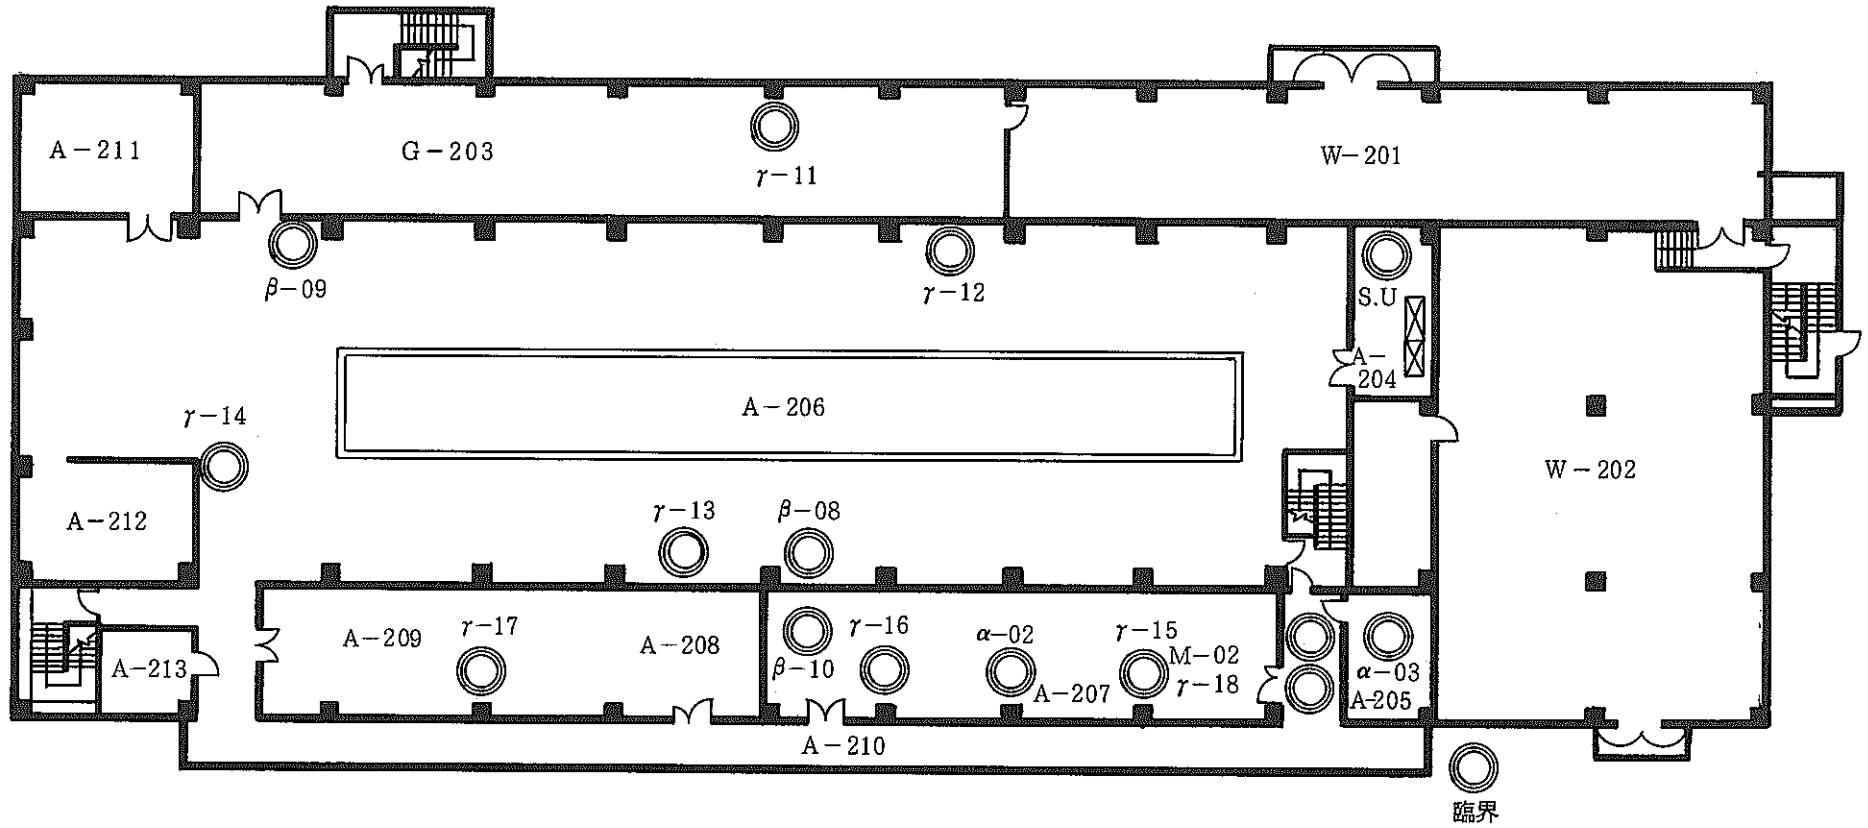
8 研究棟 2 階定置式モニタ配置図
